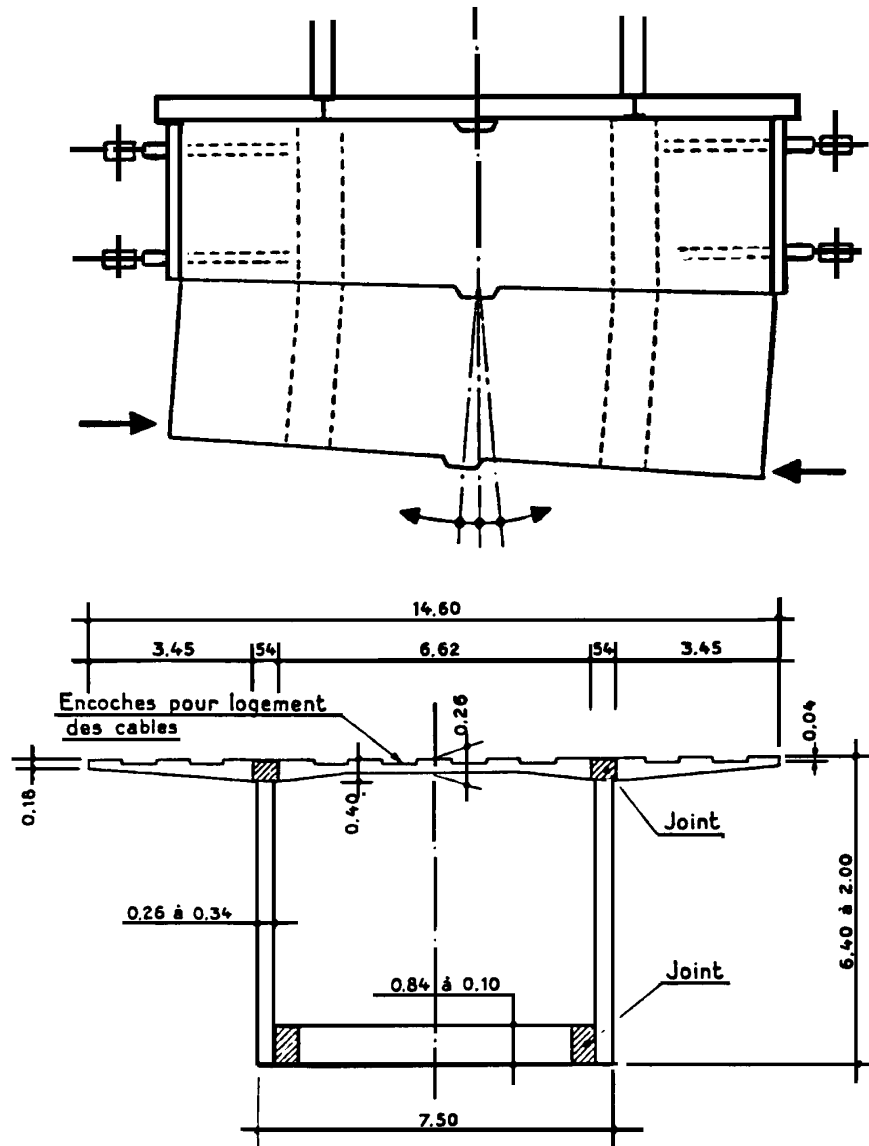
Pont de Chelepkhinsky – Coupe transversale d'un voussoir
